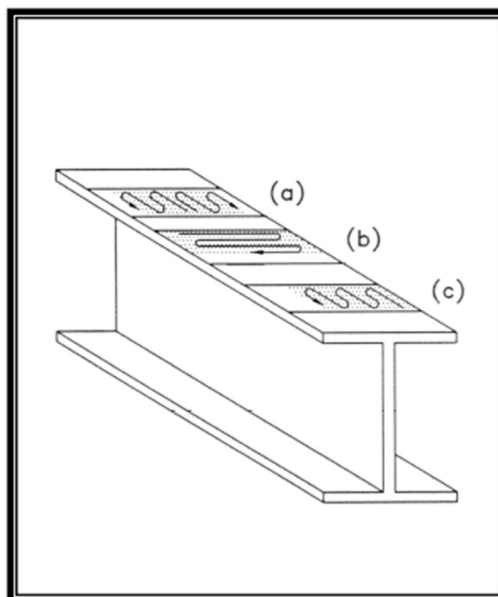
Esquema do aquecimento por faixas no banzo de uma viga laminada (FHWA, 2008)
